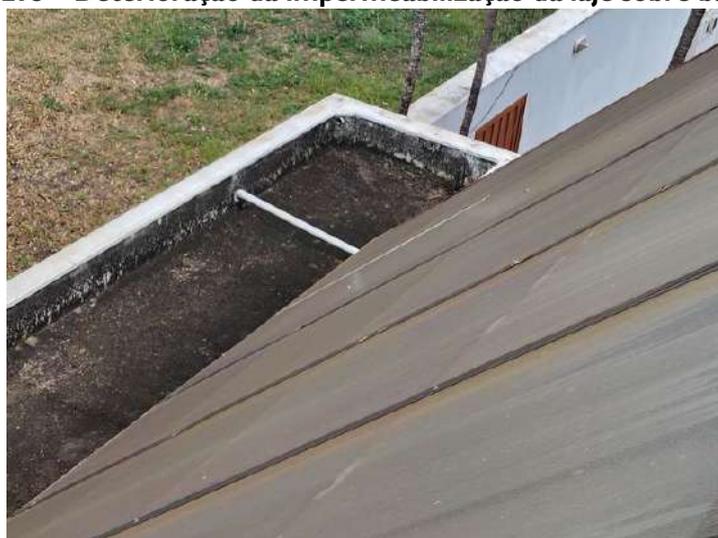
Deterioração da impermeabilização da laje sobre banheiros
